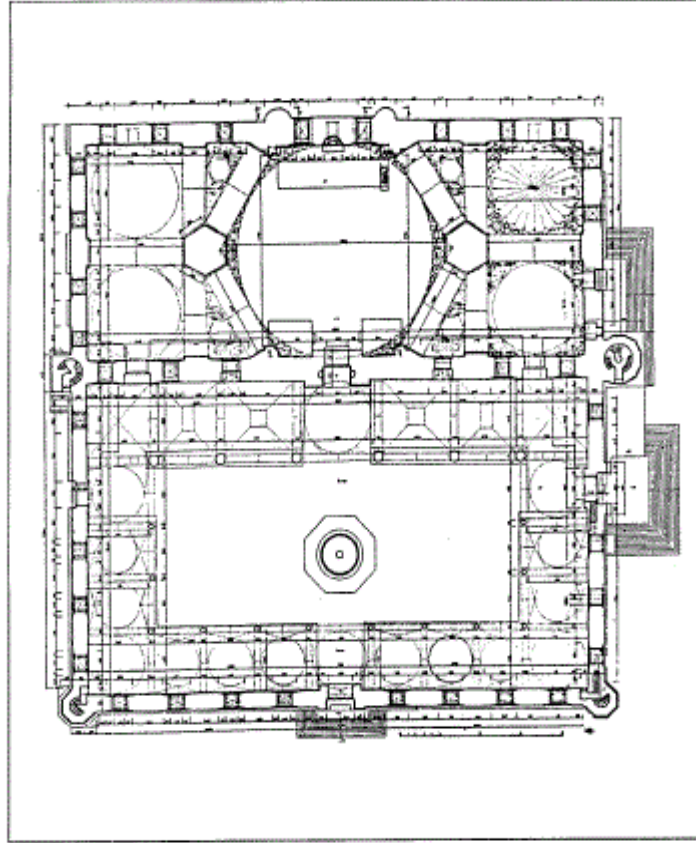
مسقط أفقي للمسجد العتيق (اسكى جامع) في يامبول (عن : كيل) .
